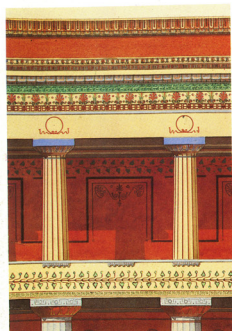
Égée, temple de Jupiter Paestum. Coupe longitudinale restaurée. Essai de Ch. Garnier, pl. 6, détail.
